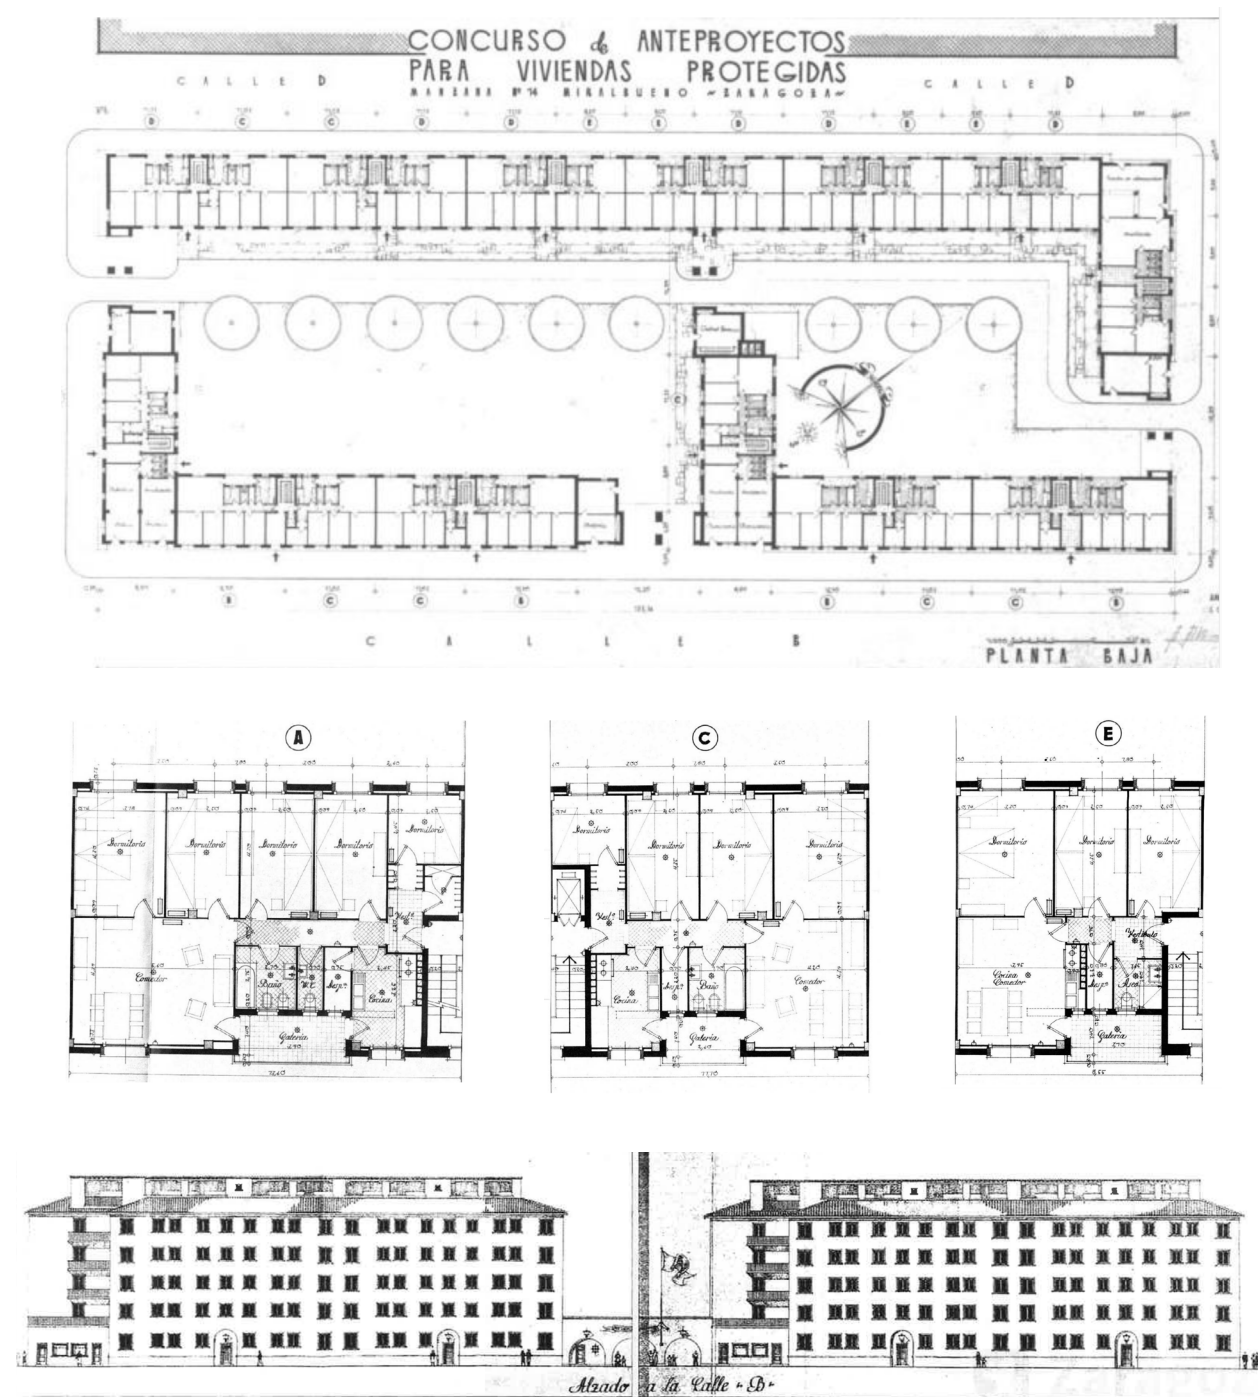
, 37, 38, 39 y 40. Planta Baja, Viviendas Tipo A-B, tipo C-D y tipo E y Alzado del Concurso para viviendas protegidas del Grupo Francisco Caballero. 1941
